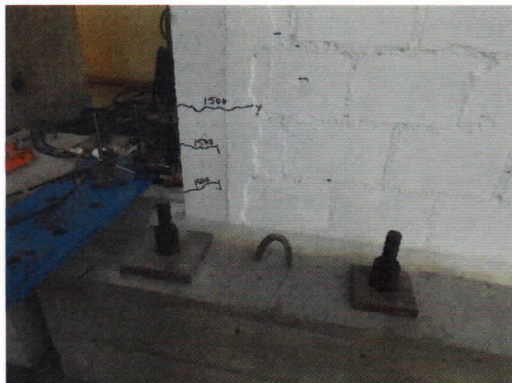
Formación de las primeras grietas en la cara sur del talón de la columna Oeste para una distorsión 1/1500.
